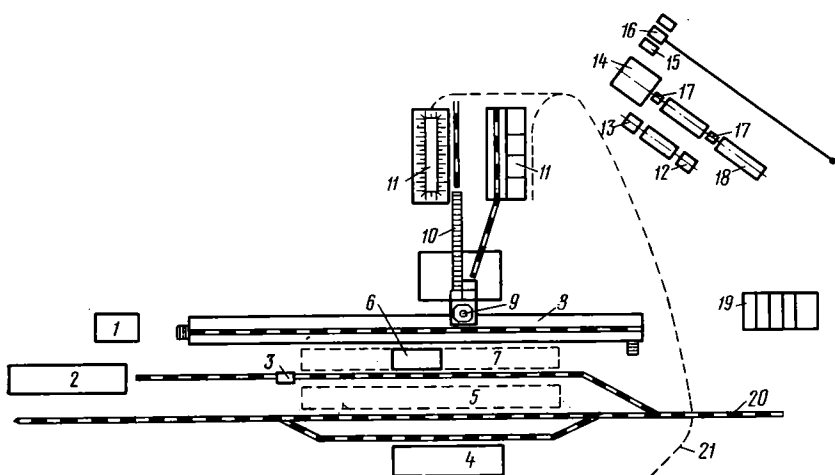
План строительной площадки при сооружении тоннеля из крупных железобетонных блоков:
